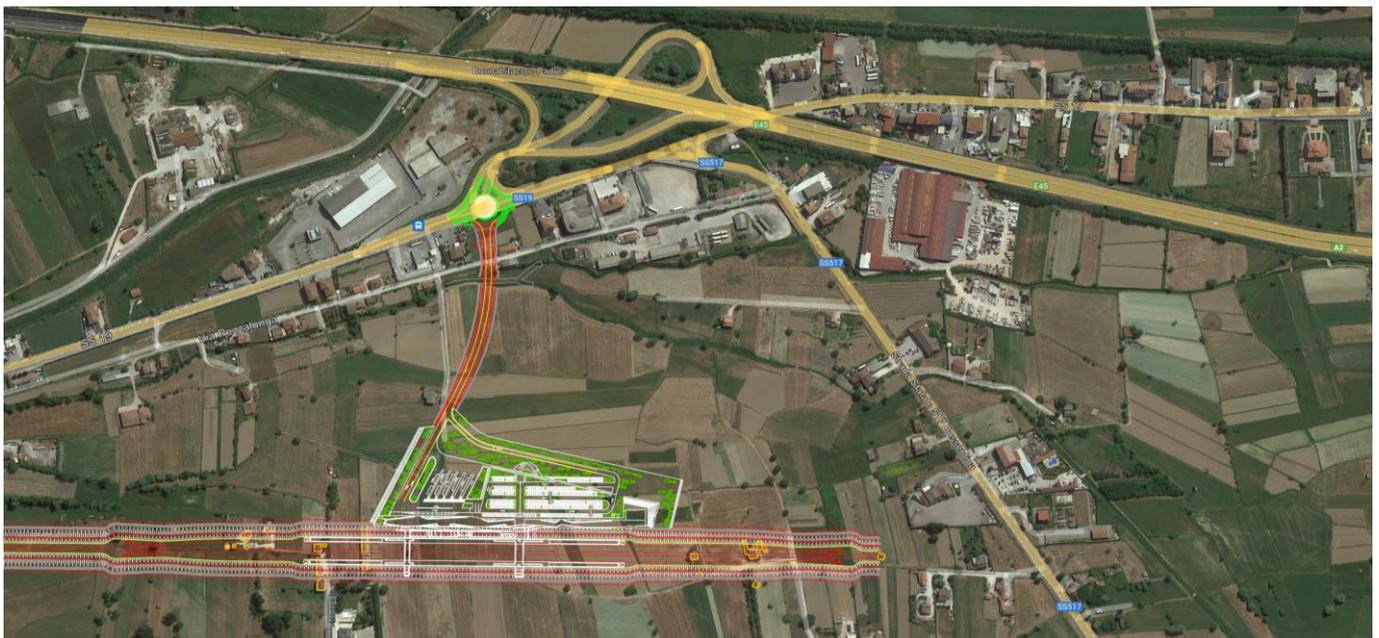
Planimetria di inquadramento su ortofoto stazione di Buonabitacolo
